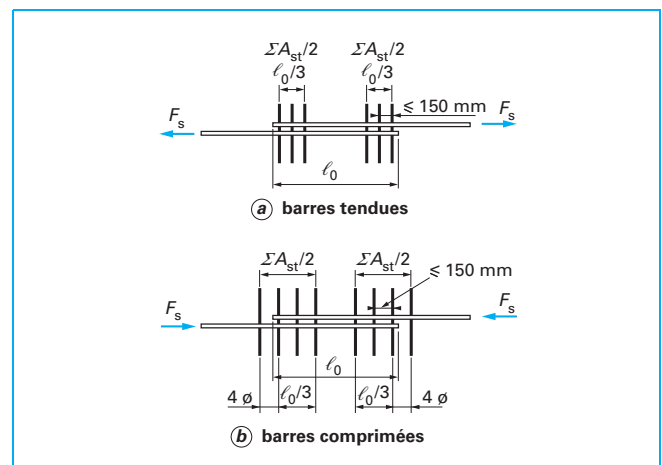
Disposition des armatures de couture d'une jonction par recouvrement (figure 8.9 de l'EC2)
